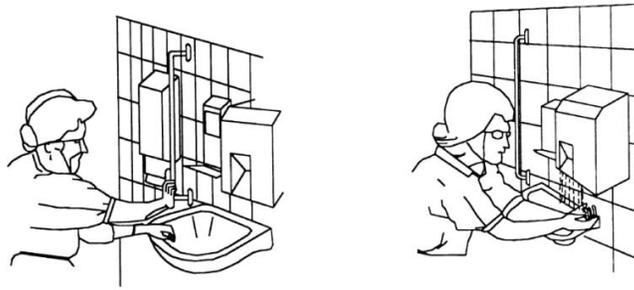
Vista Tridimensional de Aparatos y Barras de Apoyo
